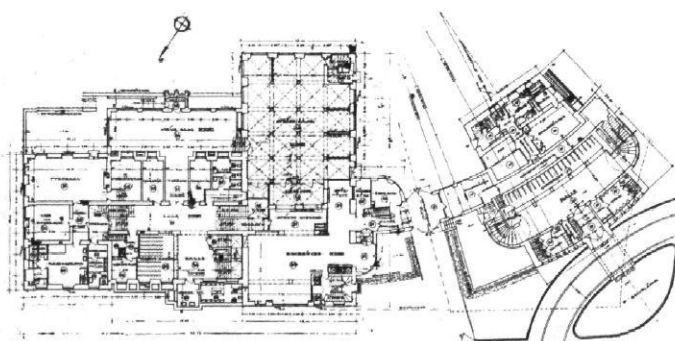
und 2 / Das „Harnack-Haus“ in Berlin-Dahlem / Architekt: Carl Sattler, München / Grundrisse des Sockelgeschosses und des Erdgeschosses 1:1000
